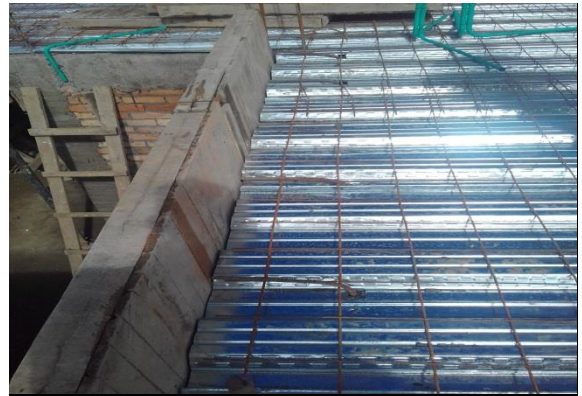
Colocación de aceros para las losas de entepiso, fuente propia
